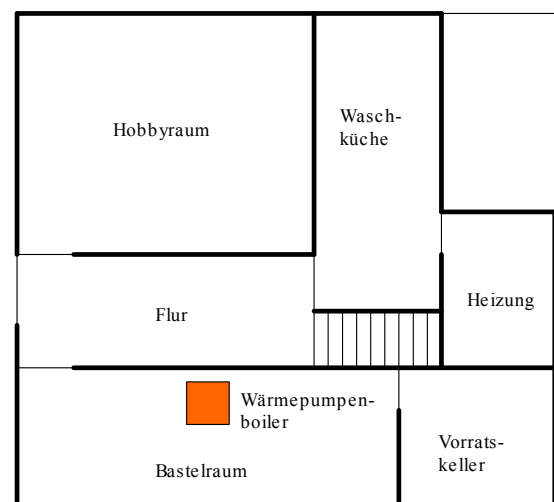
Grundriss Kellergeschoss Obstweg 12
